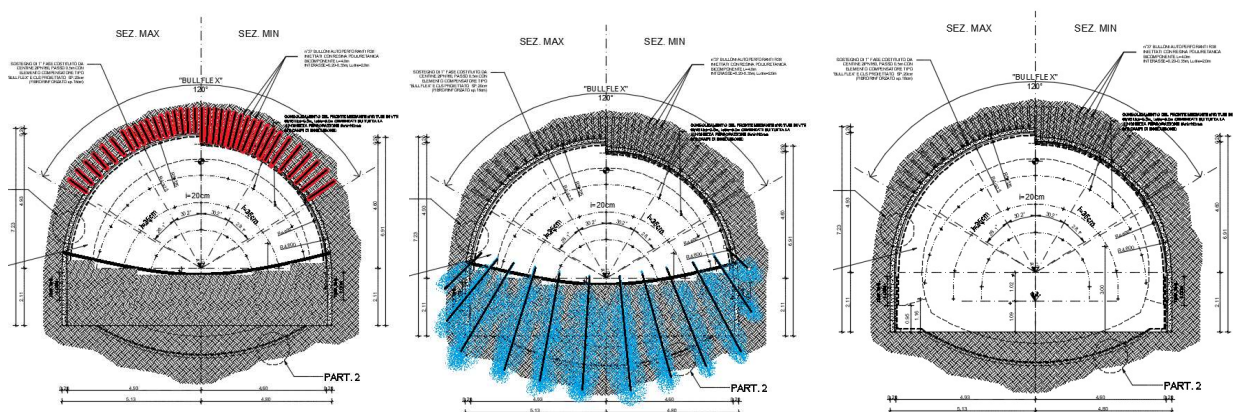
Schema consolidazione arco rovescio eseguita dall'interno del tunnel
